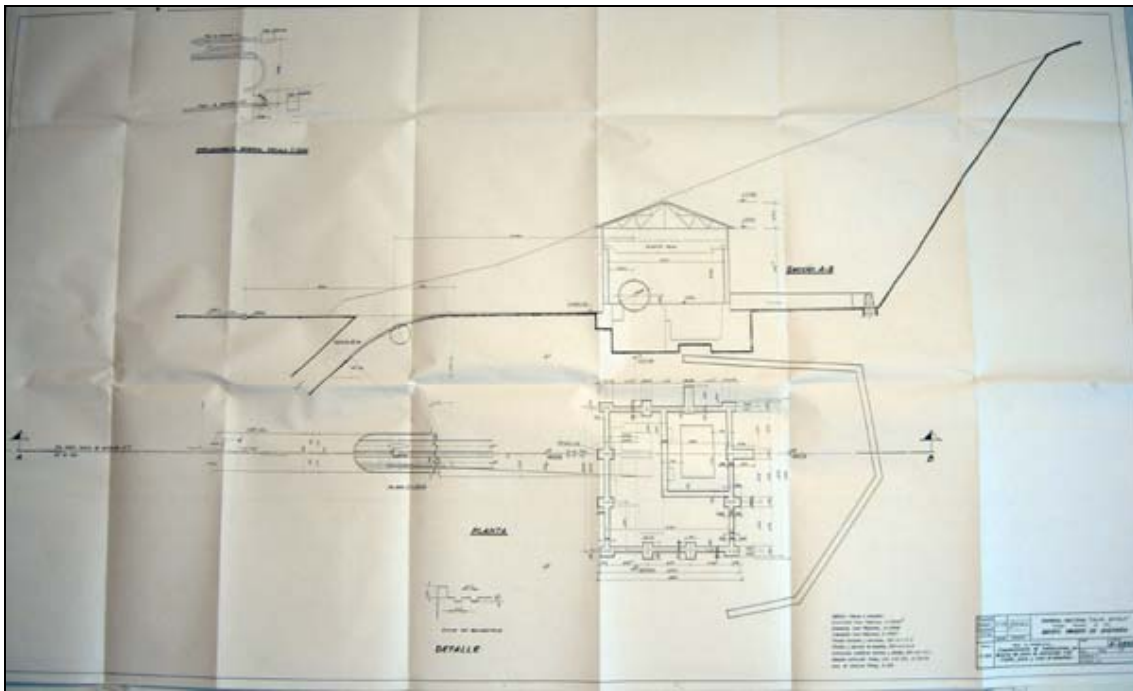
Plano donde se observa la instalación de la máquina ROBEY, en la sala de máquinas del plano n° 2 de mina La Oportuna.
